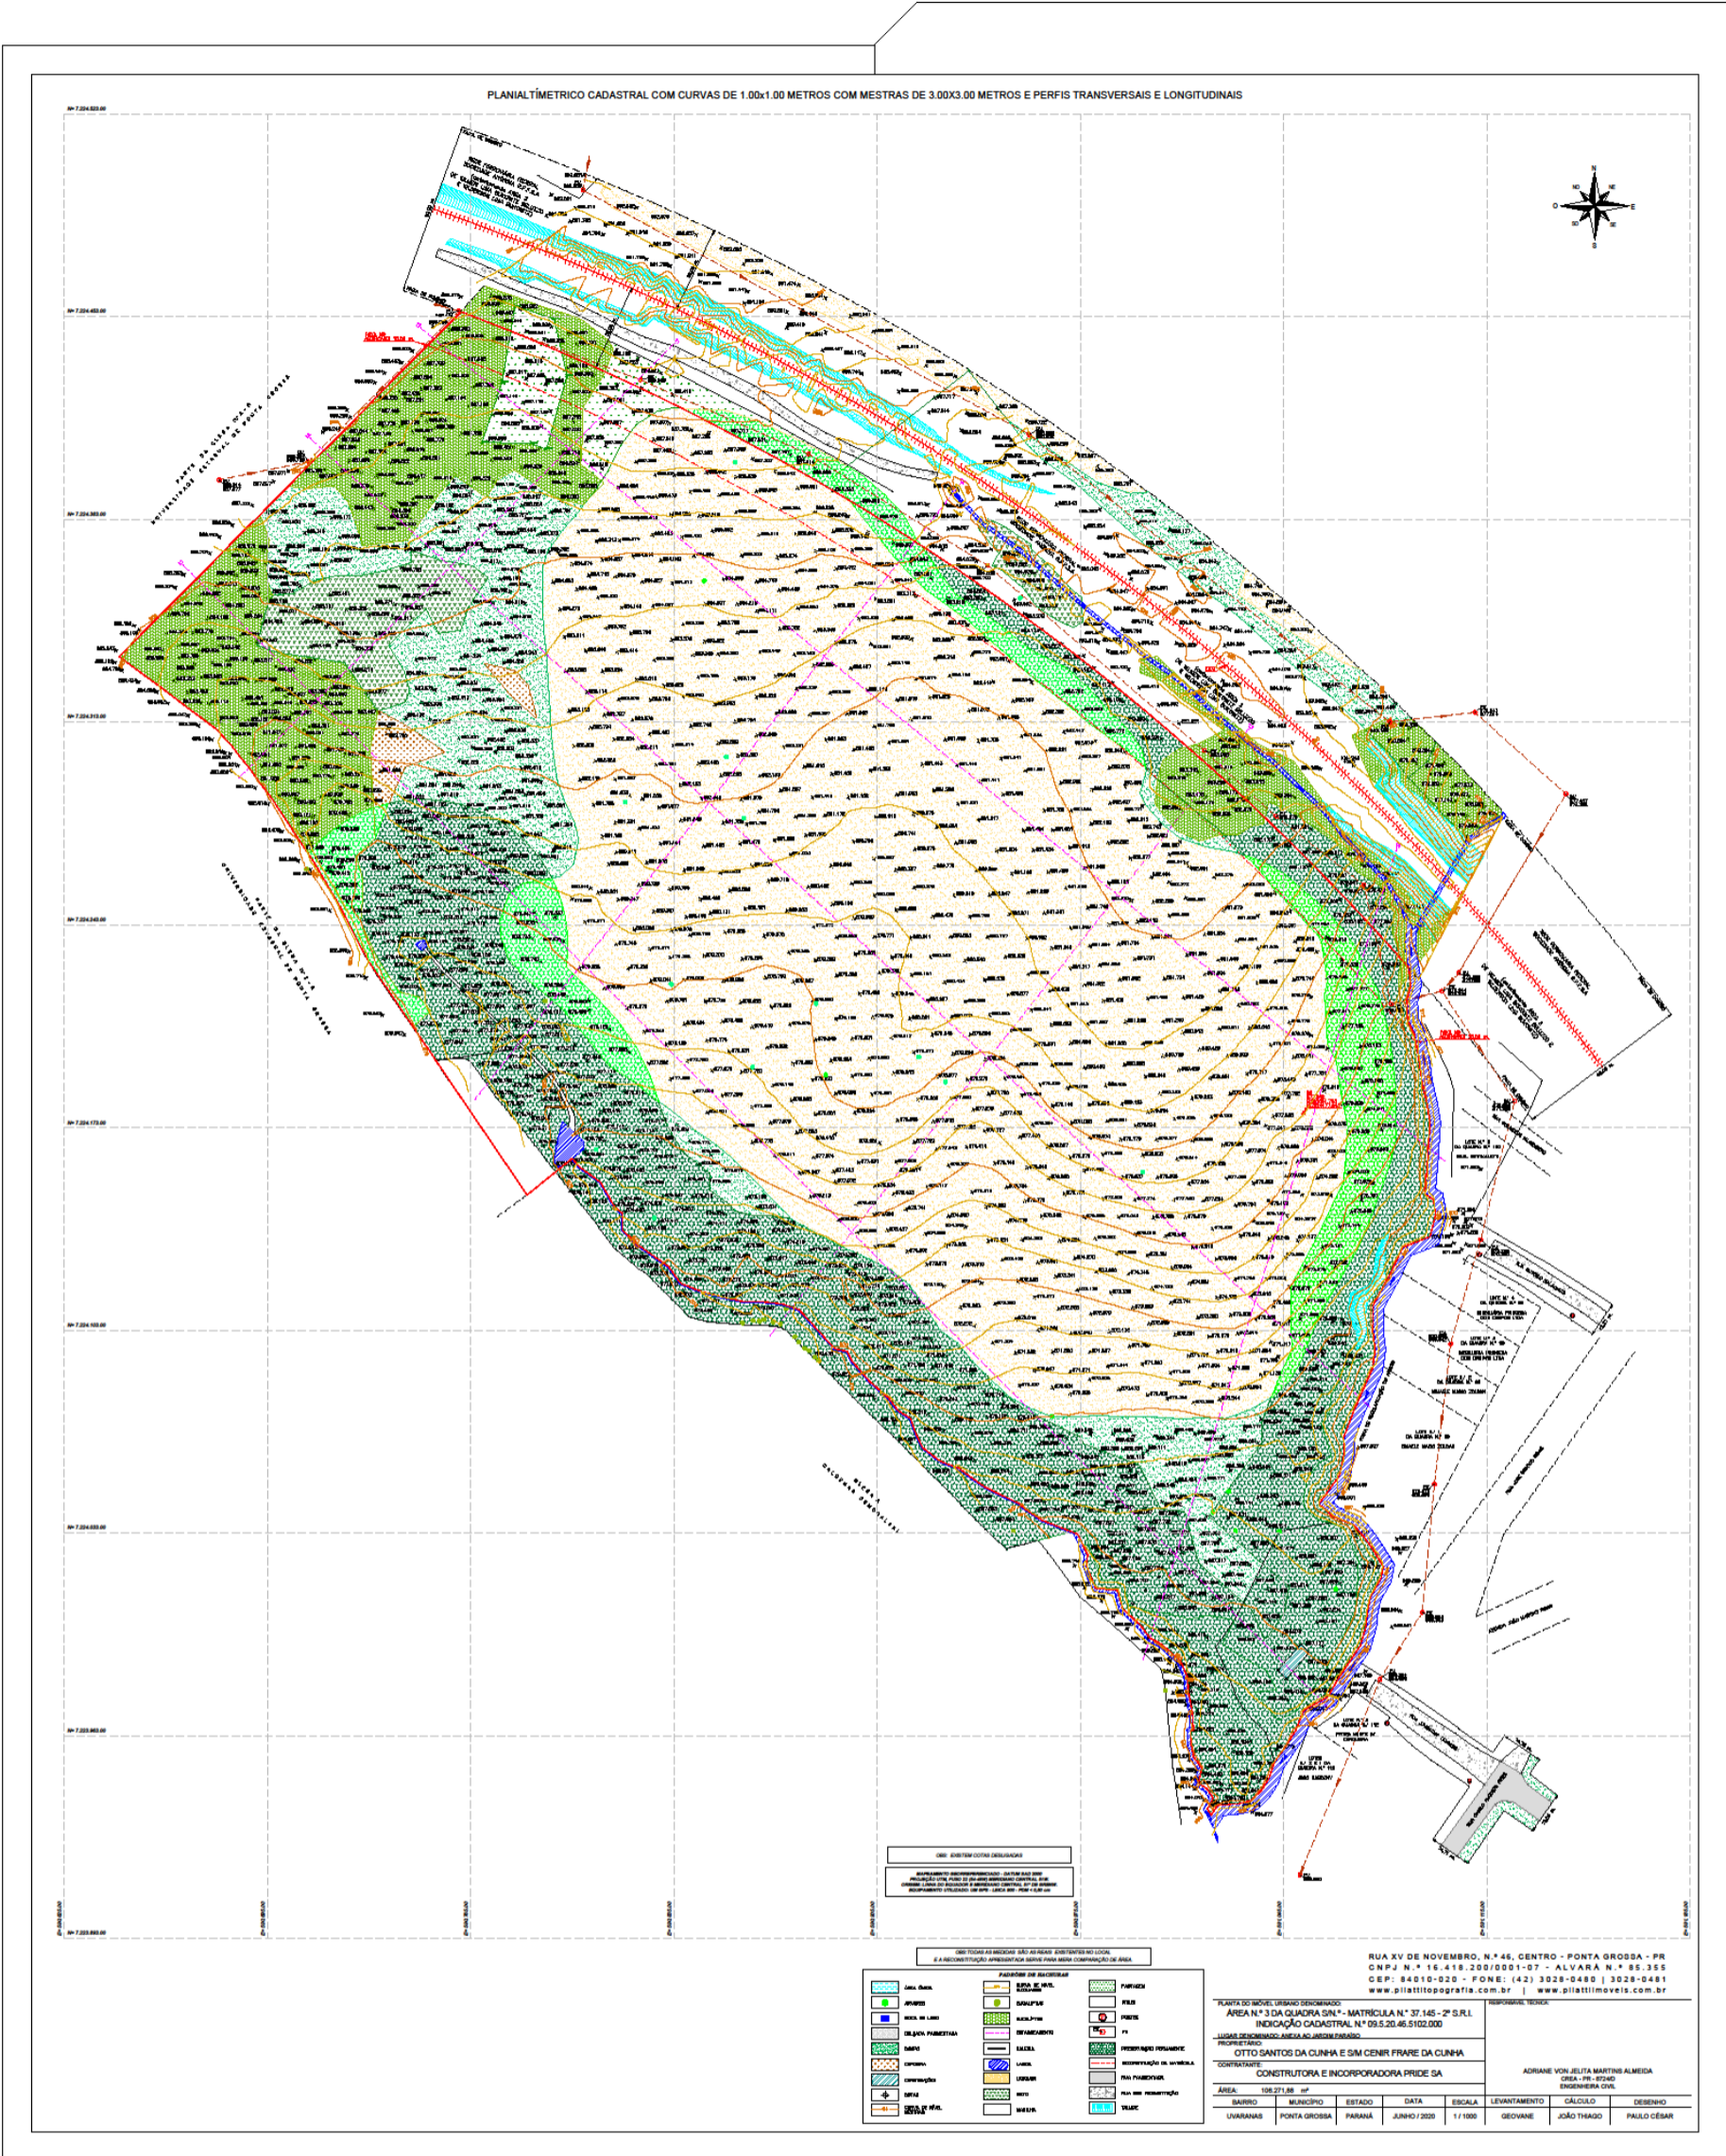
Levantamento Planialtimétrico – Matrícula 37.145.
